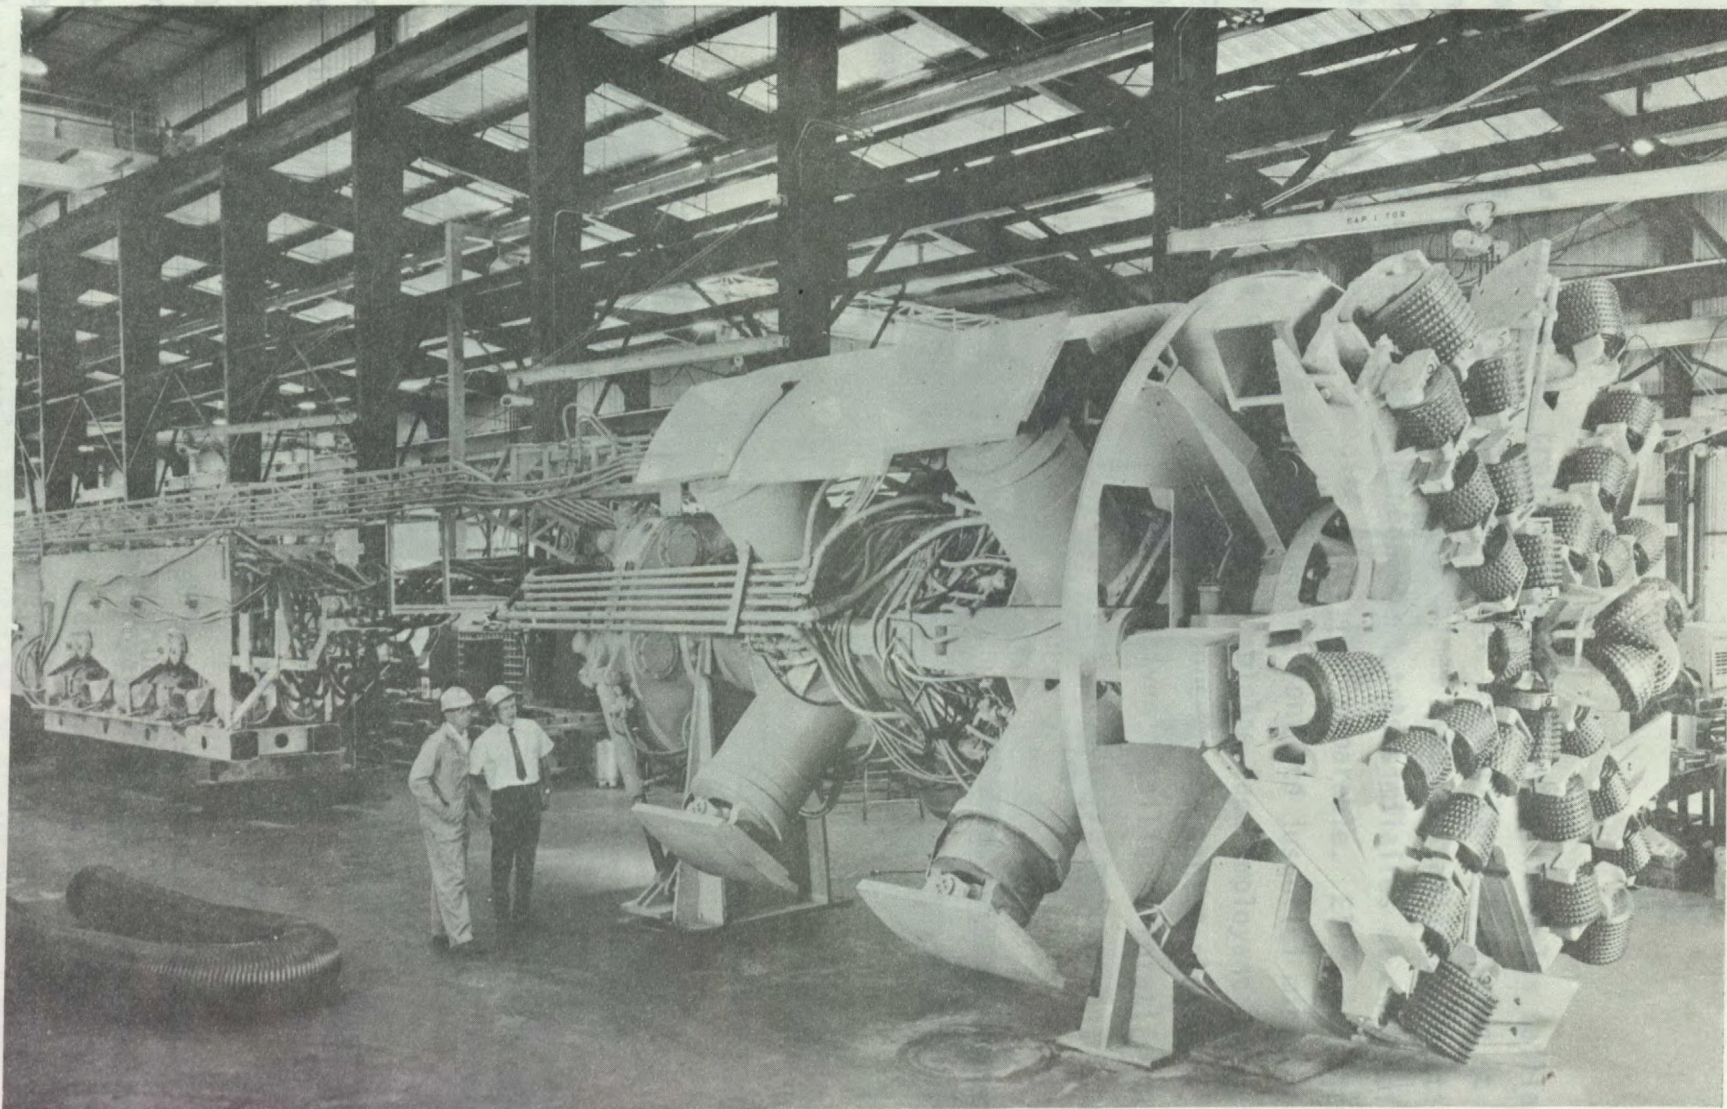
Machine de fonçage de tunnel pleine face par Caldwell.
